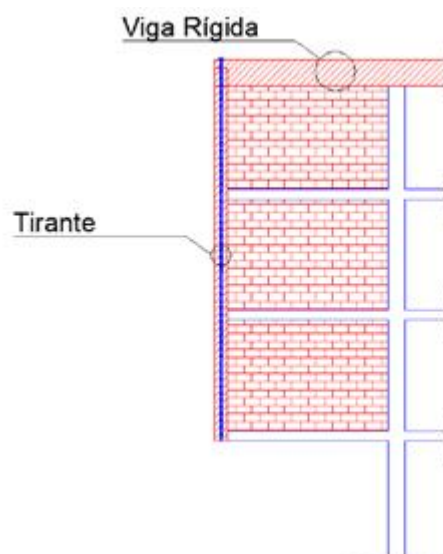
Solução com viga rígida na parte superior da estrutura [10]
